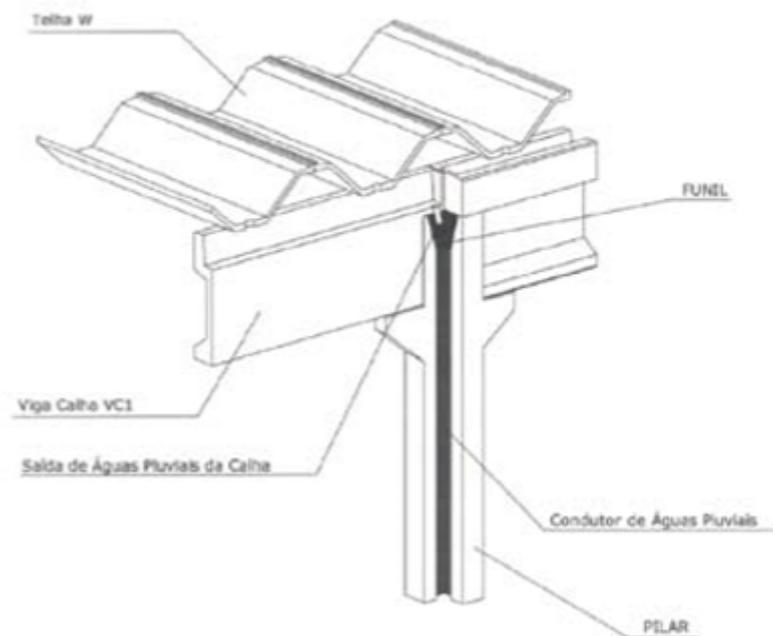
Montagem da telha pretendida de concreto (Fonte: manual da MUNTE/distribuição livre)
